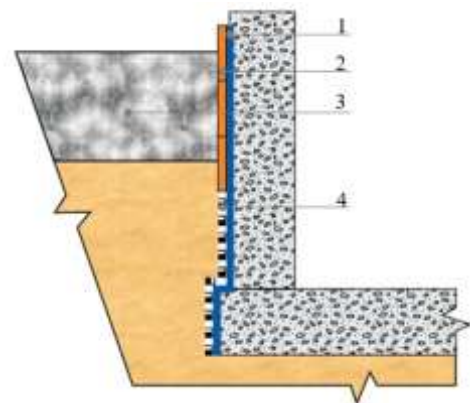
Схема утеплення підвалу будівлі на глибину промерзання ґрунту:
